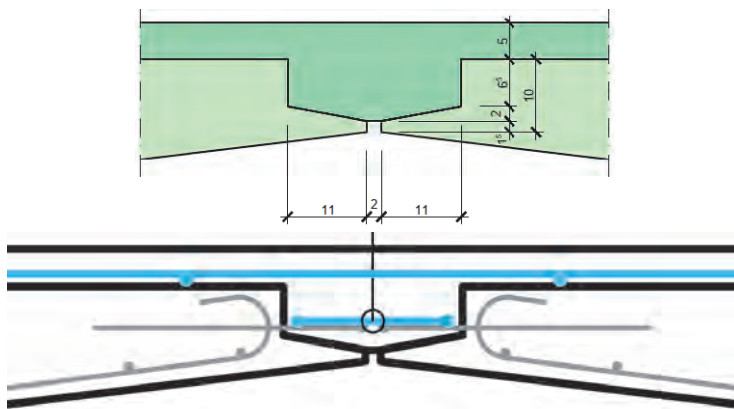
Détails du clavage longitudinal entre les poutres (extrait plan d'exécution OPAN concept)
